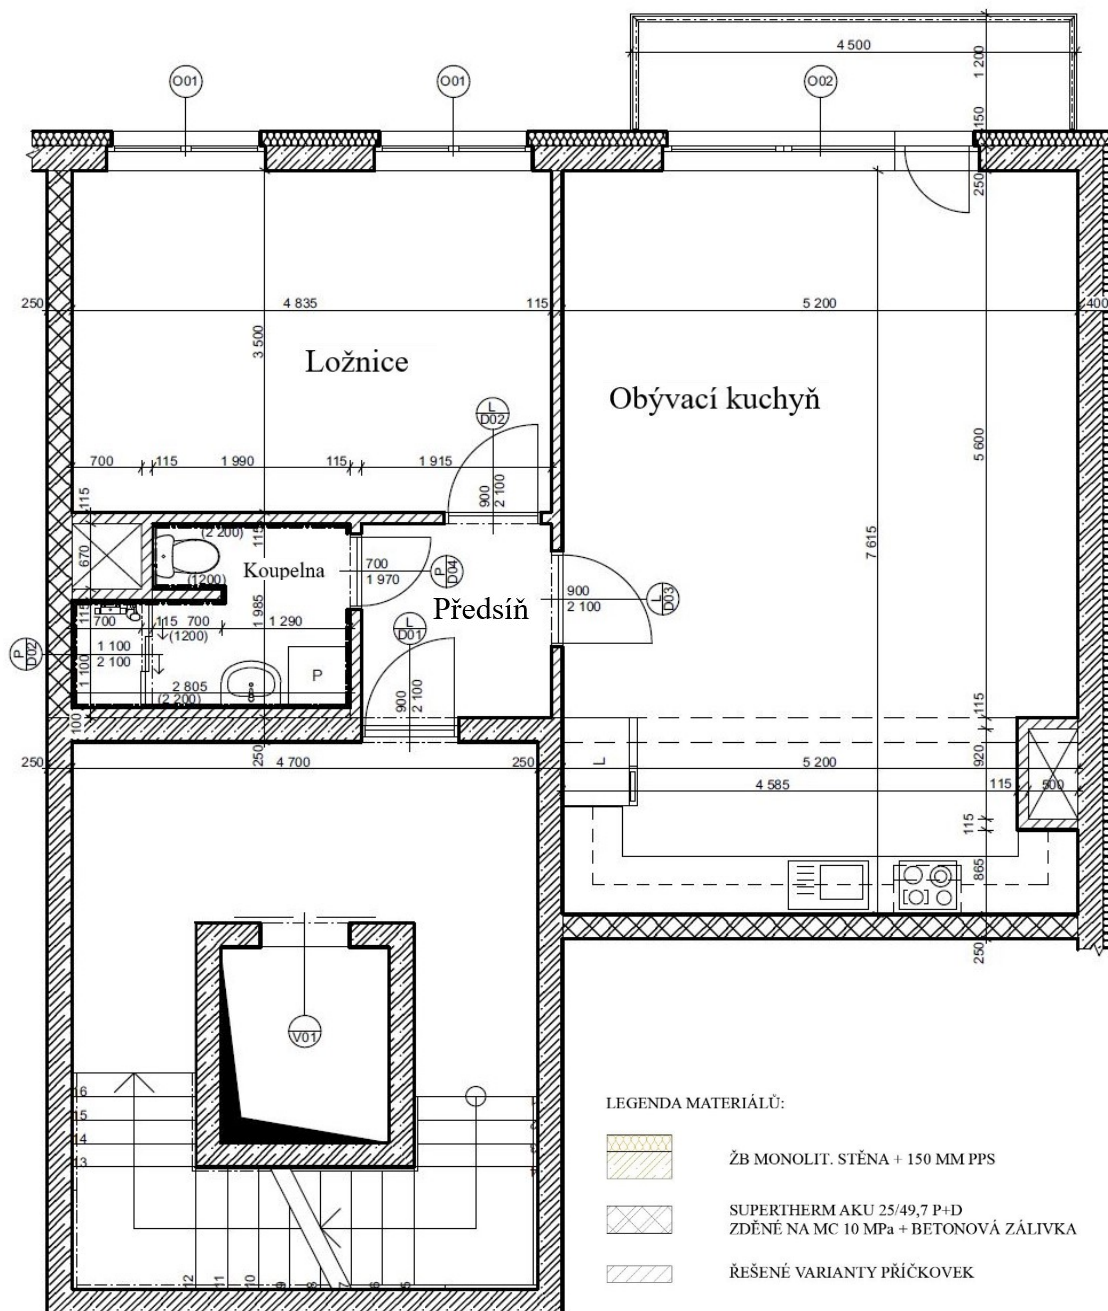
Výřez půdorysu řešených bytů – původní stav
